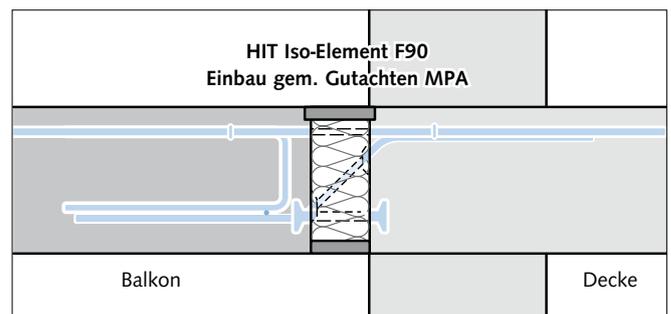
Ausführung F120 – Element F90 + Einbau gem. Gutachten MPA
